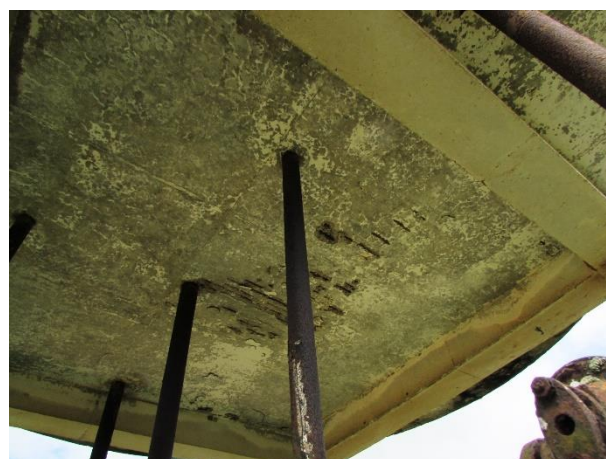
Vista da laje inferior da cuba do reservatório com corrosão da armadura
